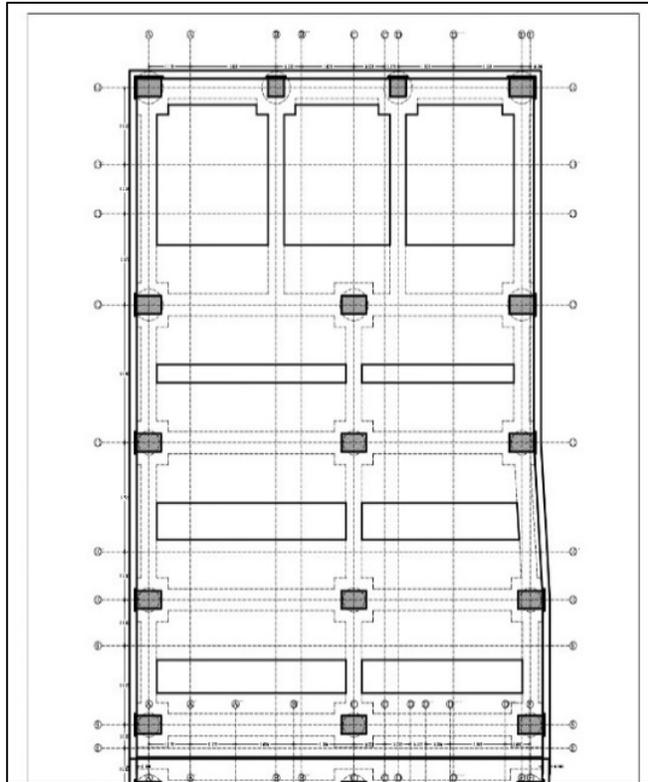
, tipología pilotes bloque 2. Fuente: Constructora Open House.
